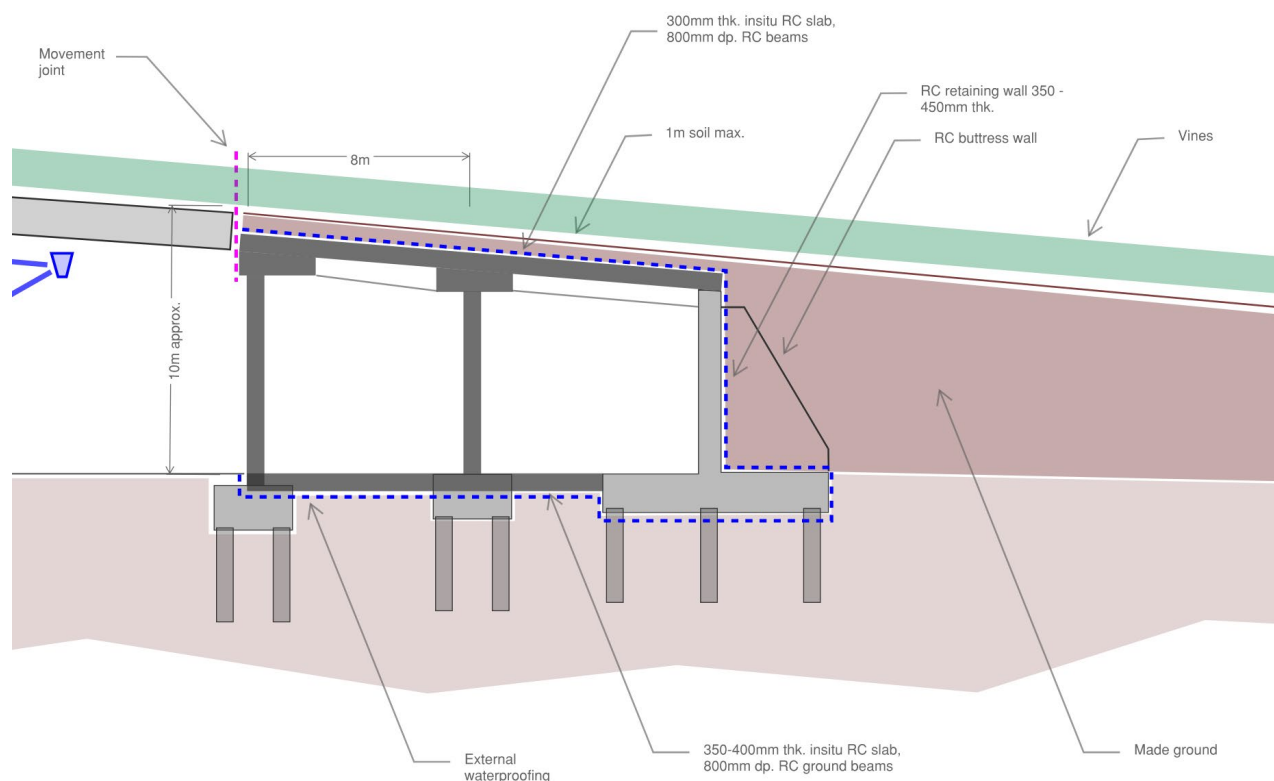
Vigneto e locale tecnico all'interno del terrapieno
